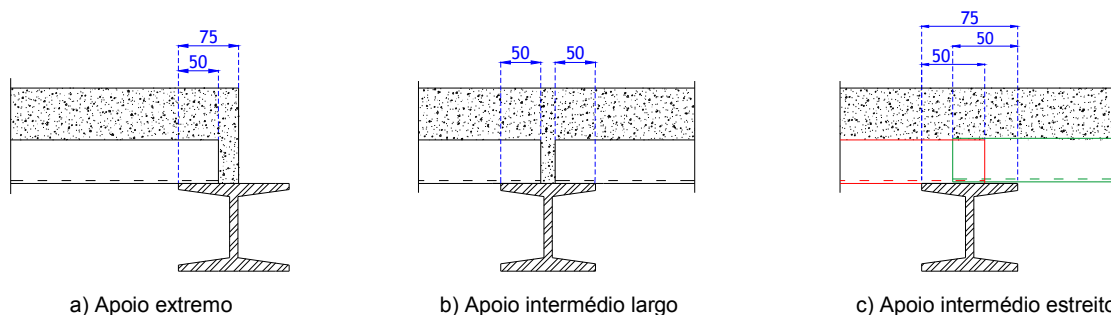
Distâncias mínimas [mm] de apoio em vigas metálicas.
